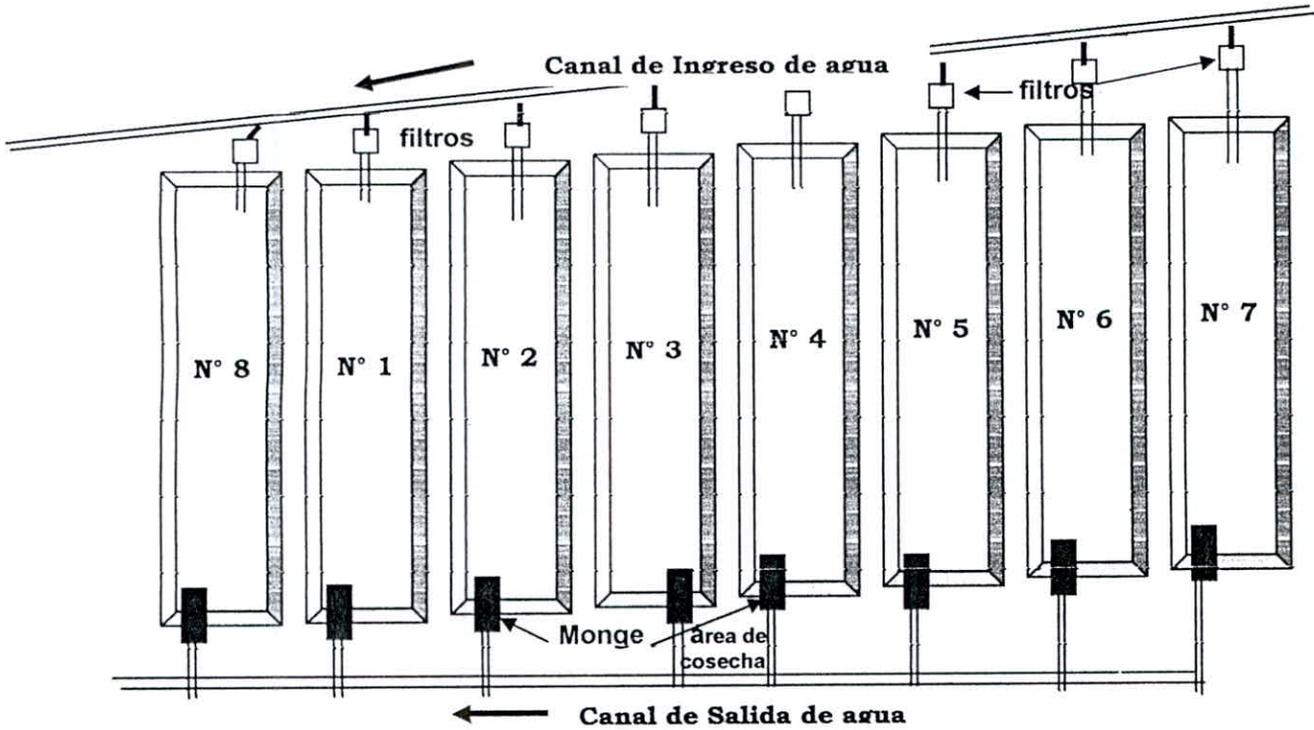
Vista en planta de los estanques para la etapa de engorde
